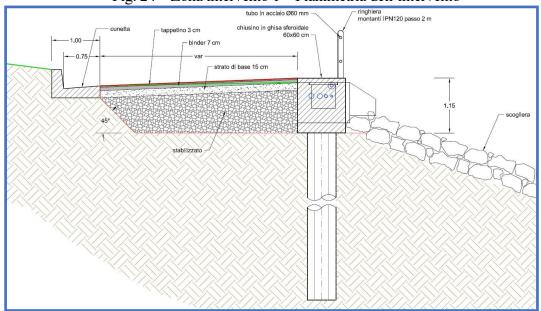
Zona intervento 1 – Sezione tipo dell'intervento
